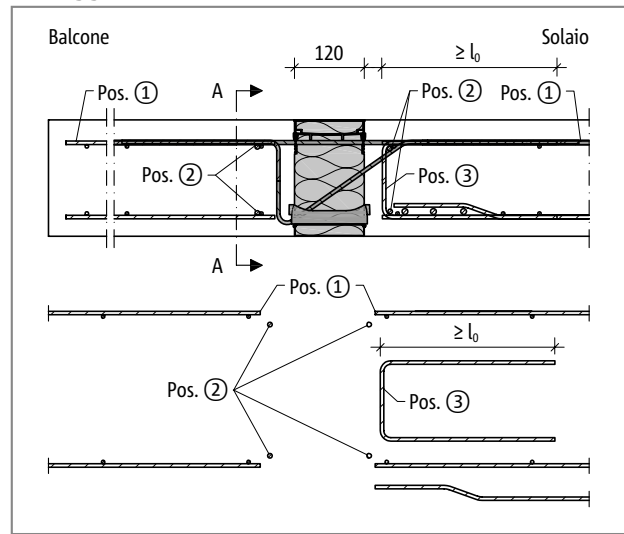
Schöck Isokorb® tipo KXT: armatura in opera con appoggio indiretto
